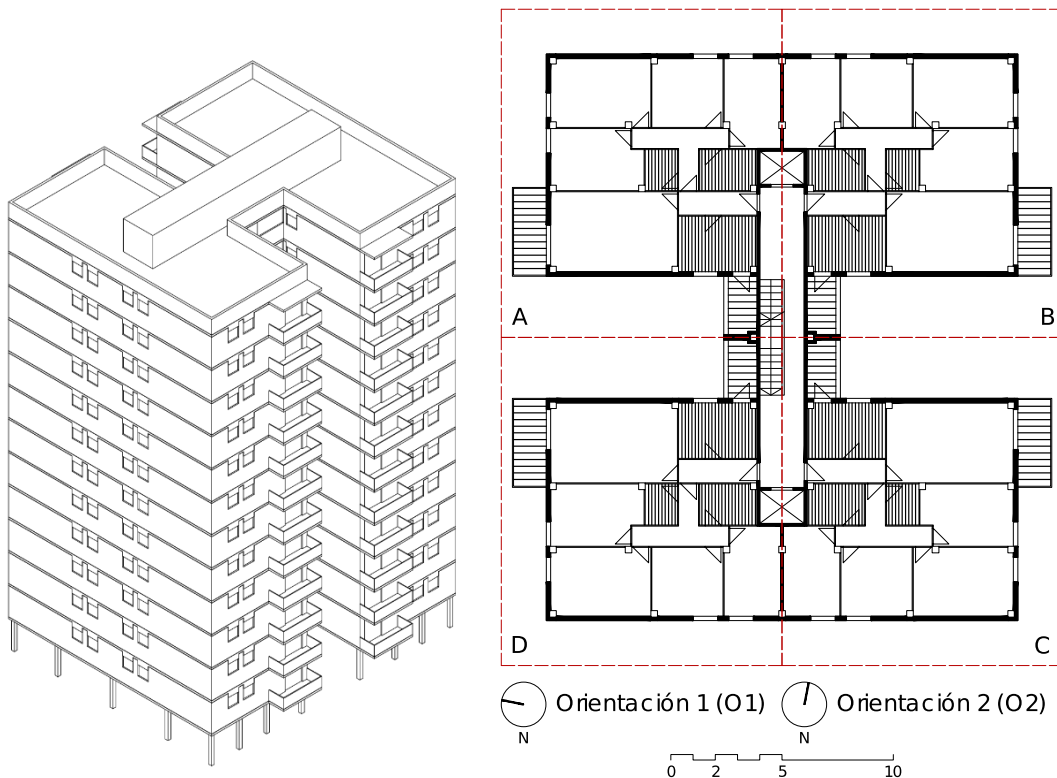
Volumetría y planta tipo del conjunto de células urbanas. Fuente: Elaboración propia a partir de información original del proyecto.
